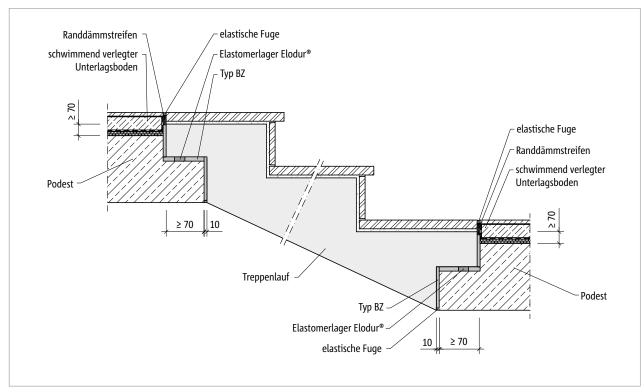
Schöck Tronsole® Typ BZ: Einbauschnitt
